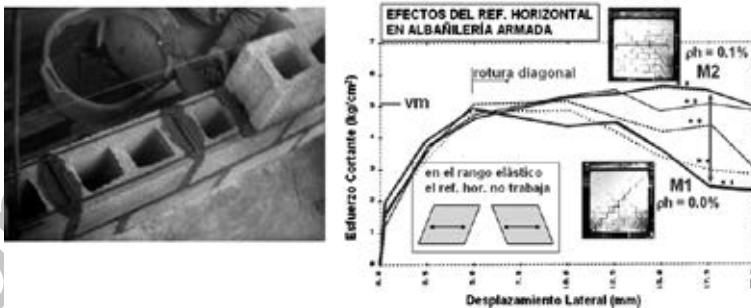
Muro M2 (reforzado horizontalmente) y M1 (sin refuerzo horizontal).
